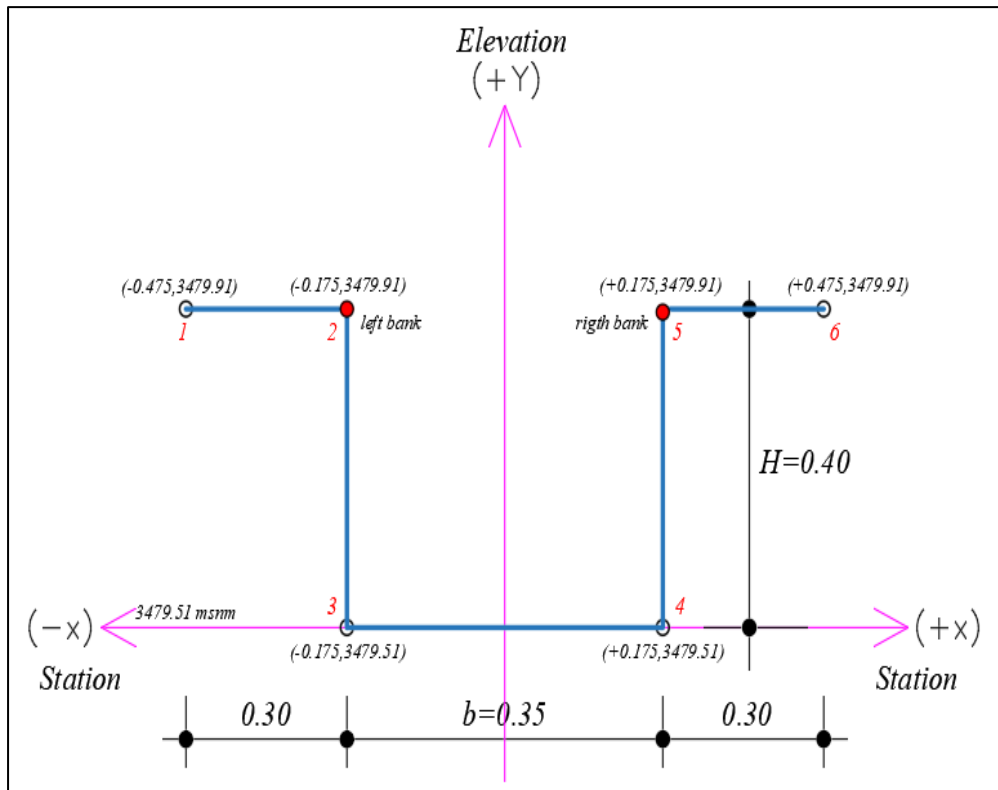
Coordenadas para la sección de concreto con máxima eficiencia.
